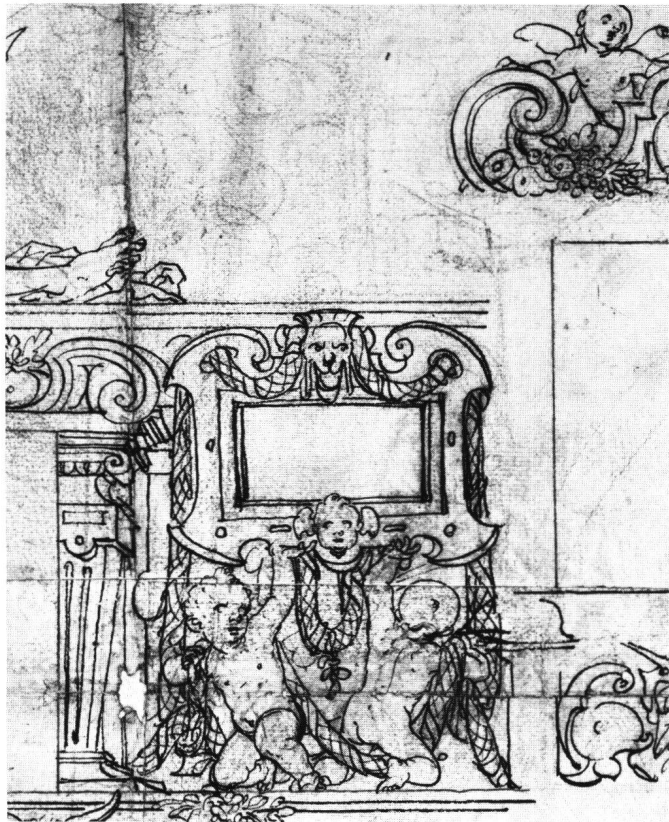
Ausschnitt aus dem Fassadenriss mit Janus (vgl. Abb. 3).
